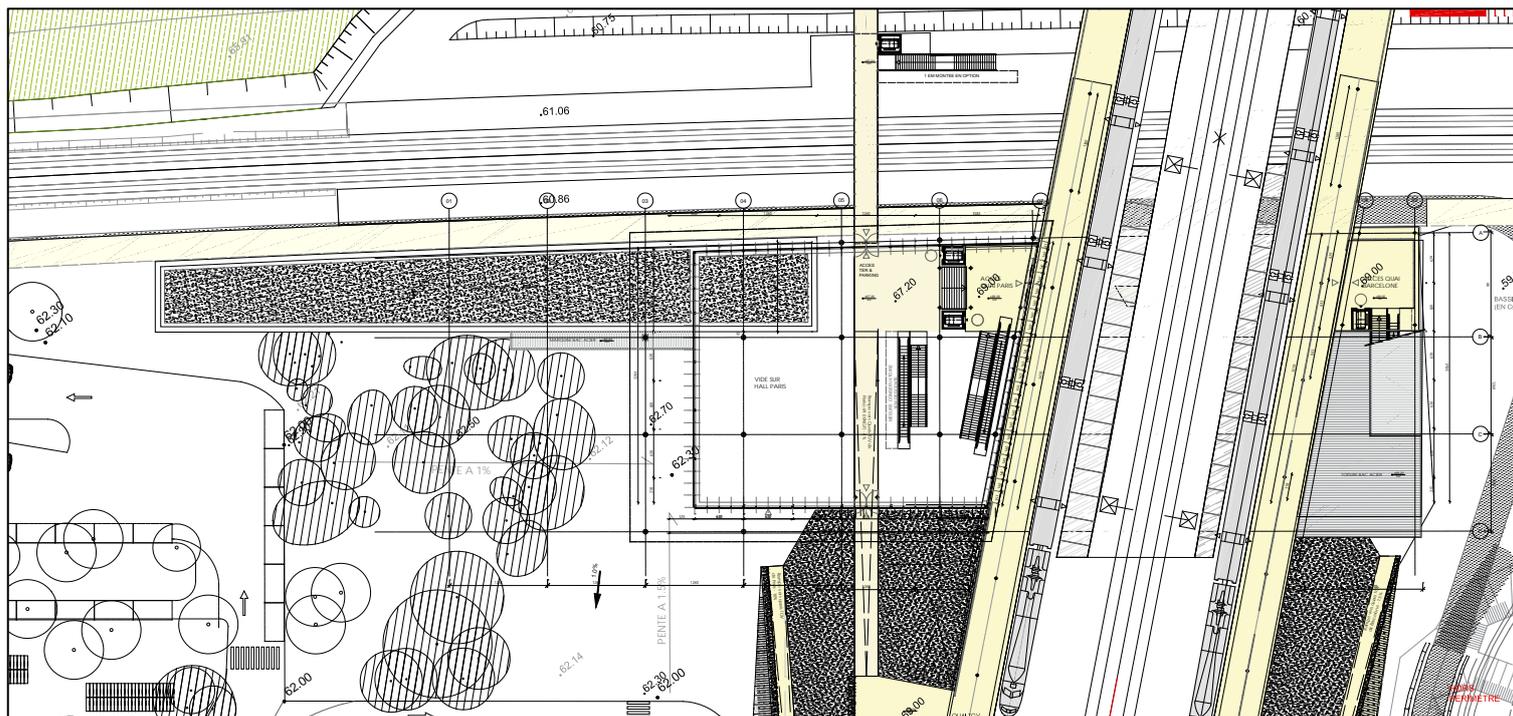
vue en plan du niveau 1, niveau passerelle et rampe talus
